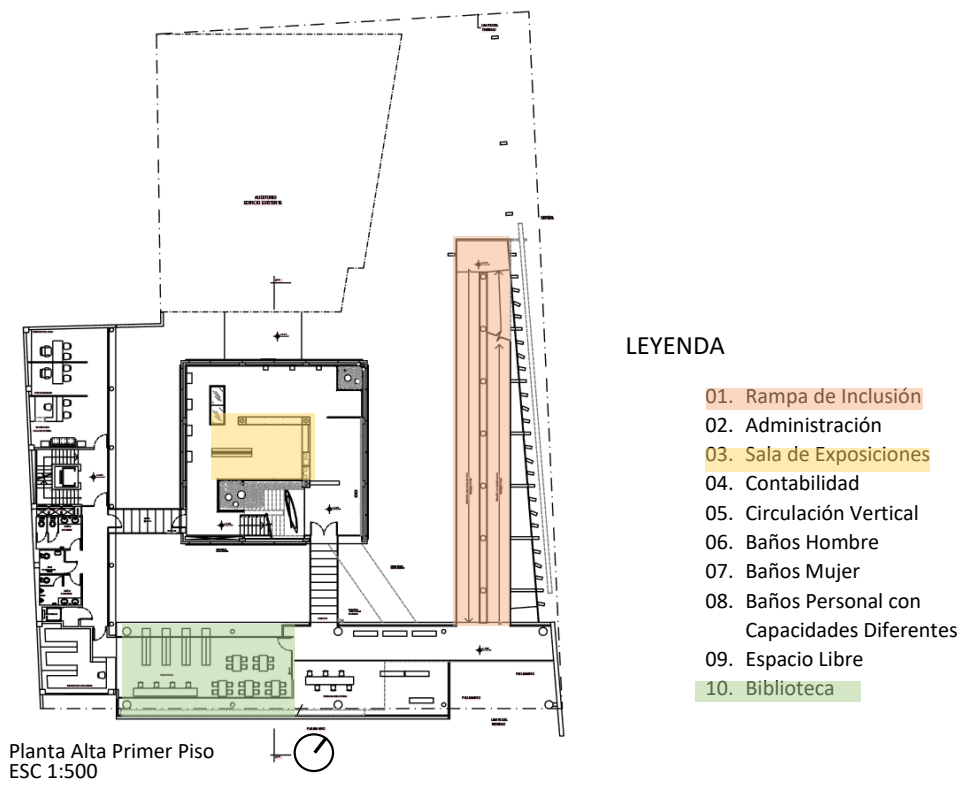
Planta Alta Primer Piso. Fuente y Elaboración: propia.
